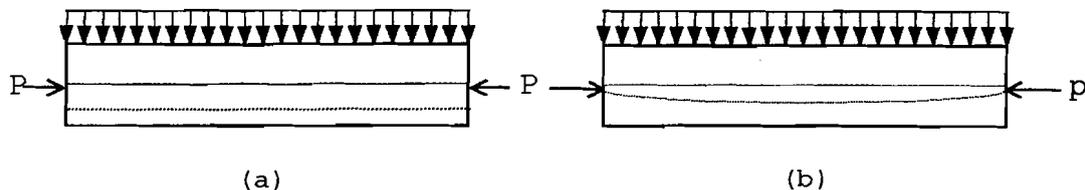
Distribusi tegangan sepanjang penampang beton tendon konsentris
